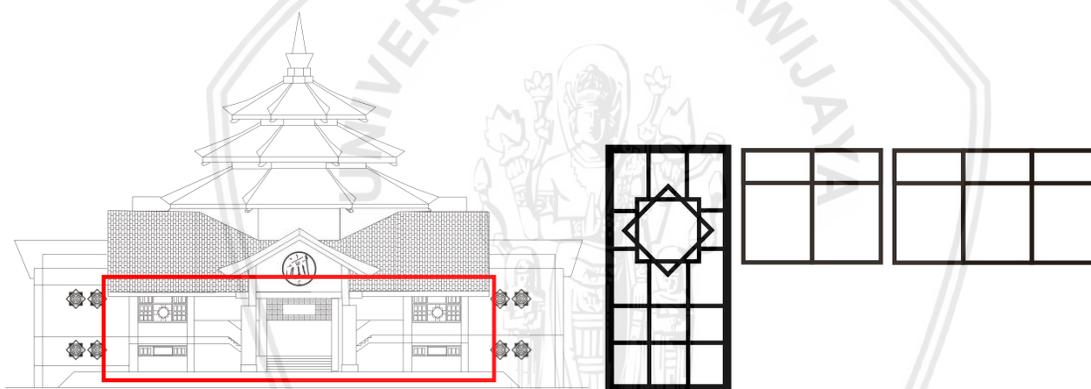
Denah Masjid Cheng Ho Pasuruan
